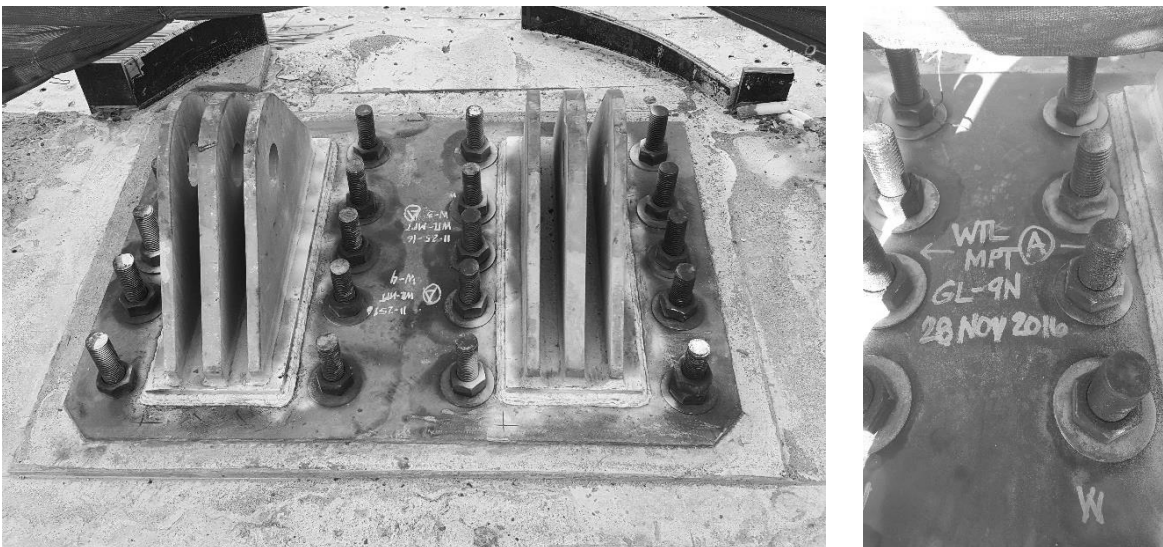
und 16: Mactan Cebu Airport, Baustellenschweißung, Prüfvermerk MPT, Fotos: RUBNER Holzbau
